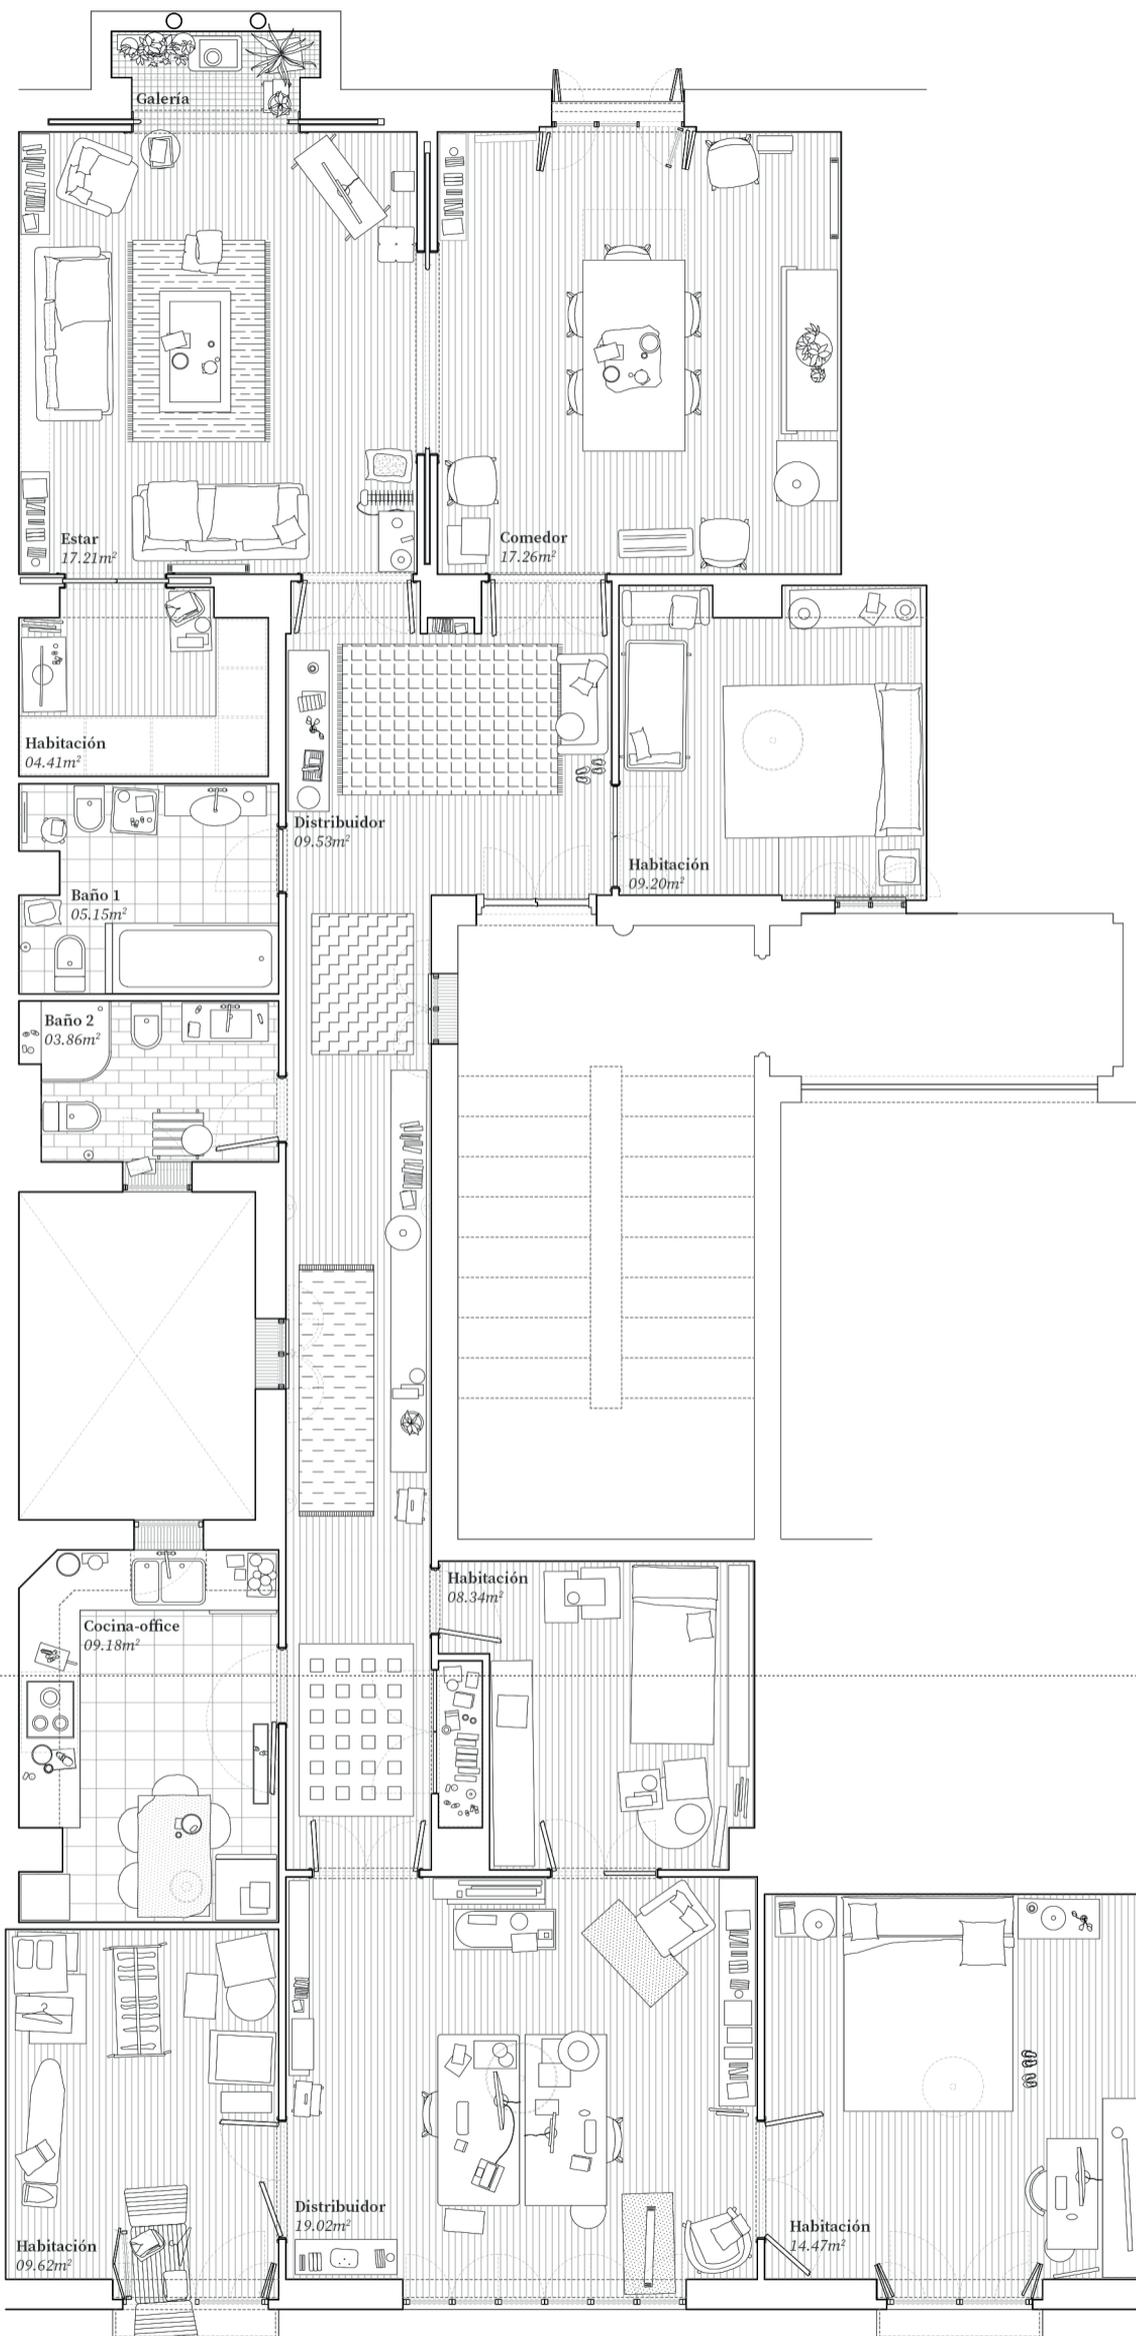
Planta de la vivienda del proyecto de Cortina. Escala 1:75. Fuente: elaboración propia.
